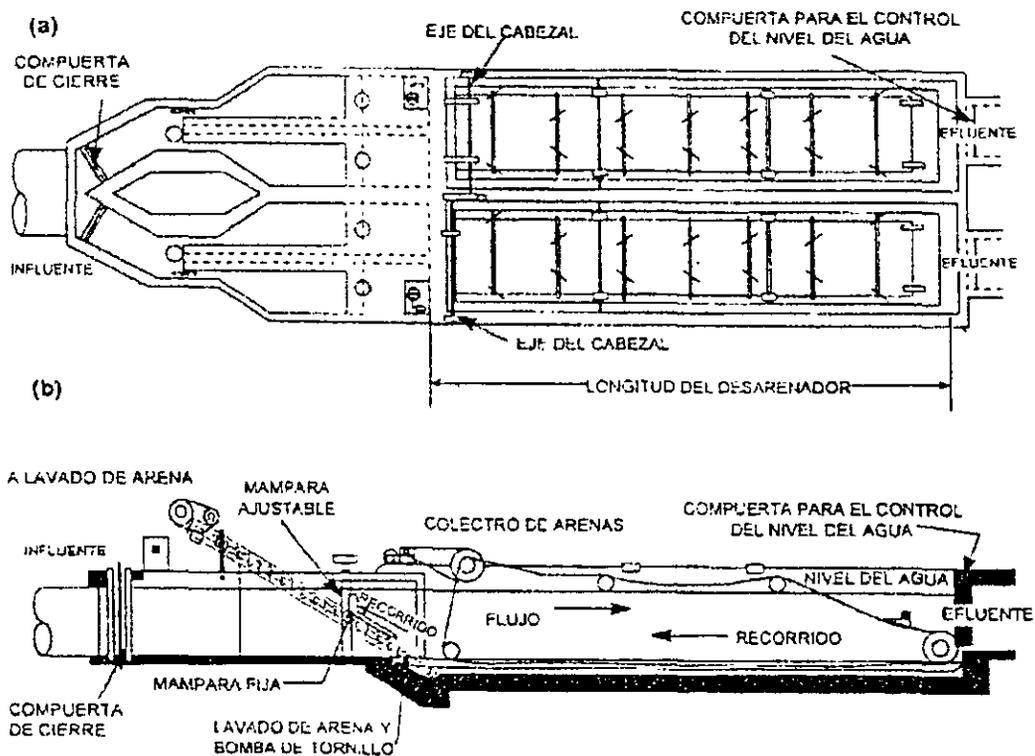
Planta y sección longitudinal de un desarenador de doble canal con depósito.
